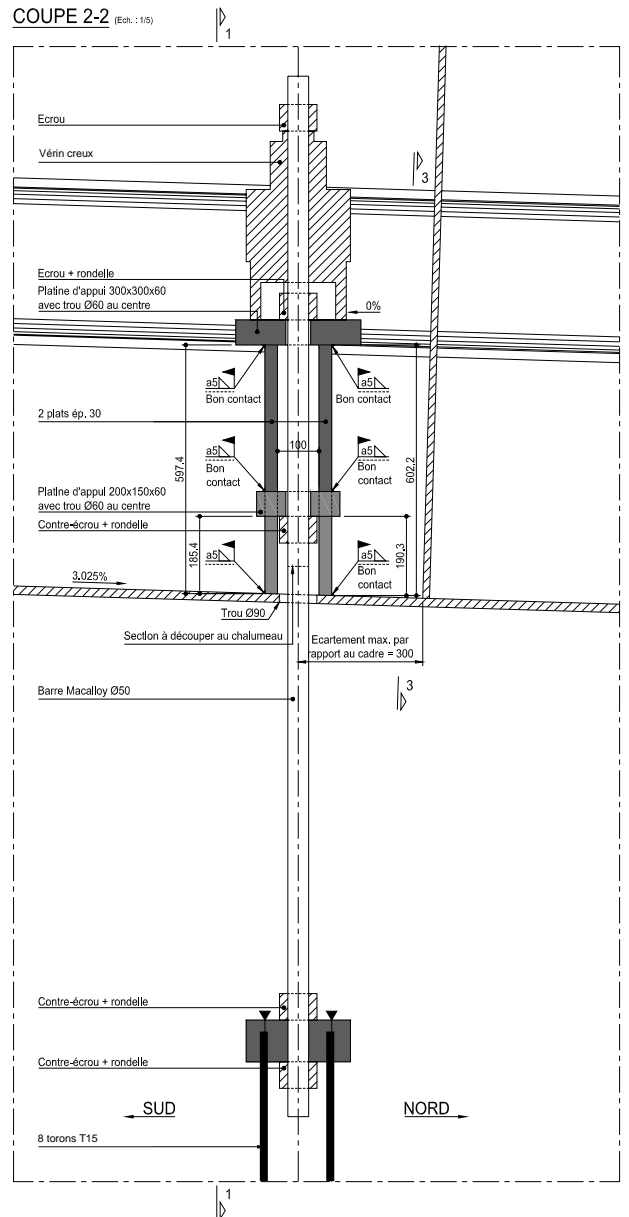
Ancrage dans le caisson central - Situé contre l'âme Ouest
